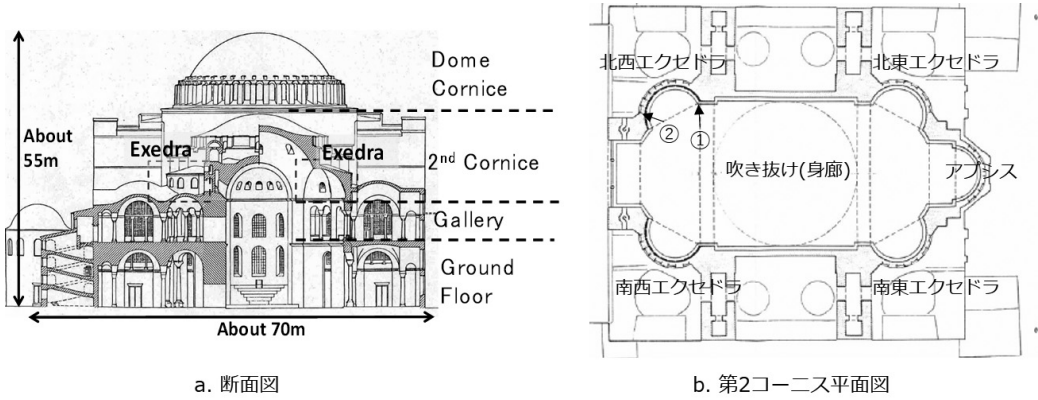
ハギア・ソフィア大聖堂の(a)断面図と(b)第2コーニスの平面図³⁾
